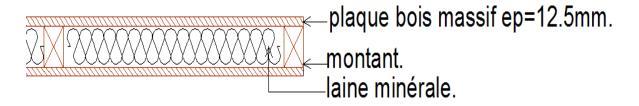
plan détail d'une cloison en bois. Source : auteurs.
